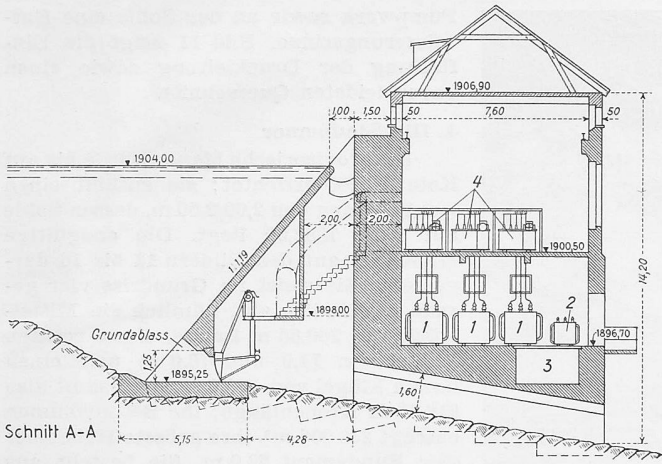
Querschnitt A-A durch das Pumpenhaus mit Grundablass und Ueberlauf, 1:300
